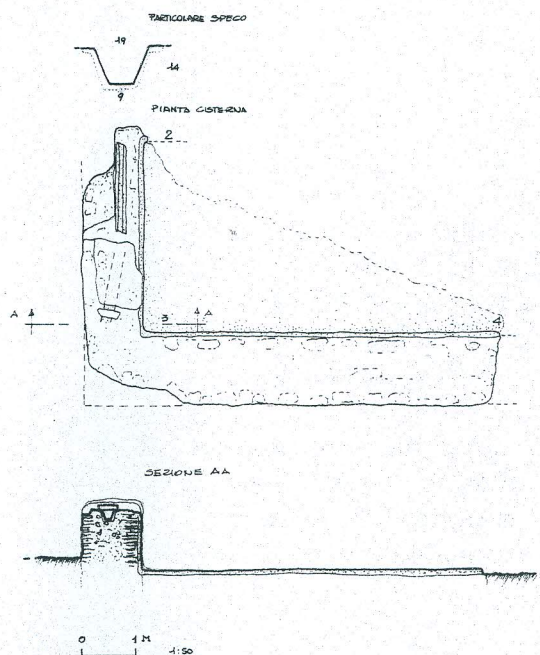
PIANTE E SEZIONE DELLA CISTERNA N. 37 CON LO SPECO CHE CORRE ATTRAVERSO IL MURO PERIMETRALE (*ril. arch. A. Chighine*).
